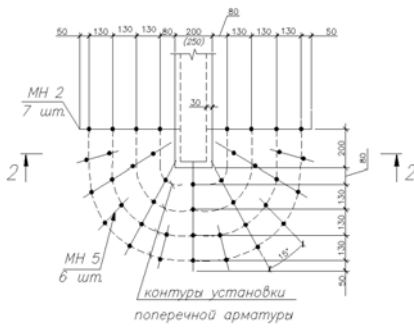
Характер поперечного армирования плиты у торца диафрагмы
